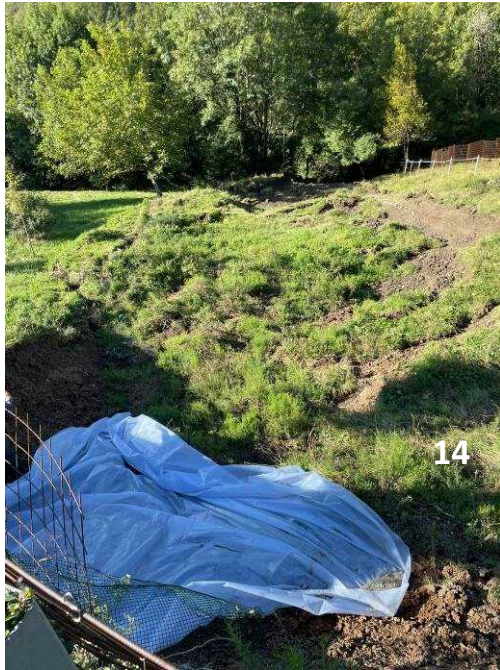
Frana n. 14 – frana attiva vista dalla strada verso valle
